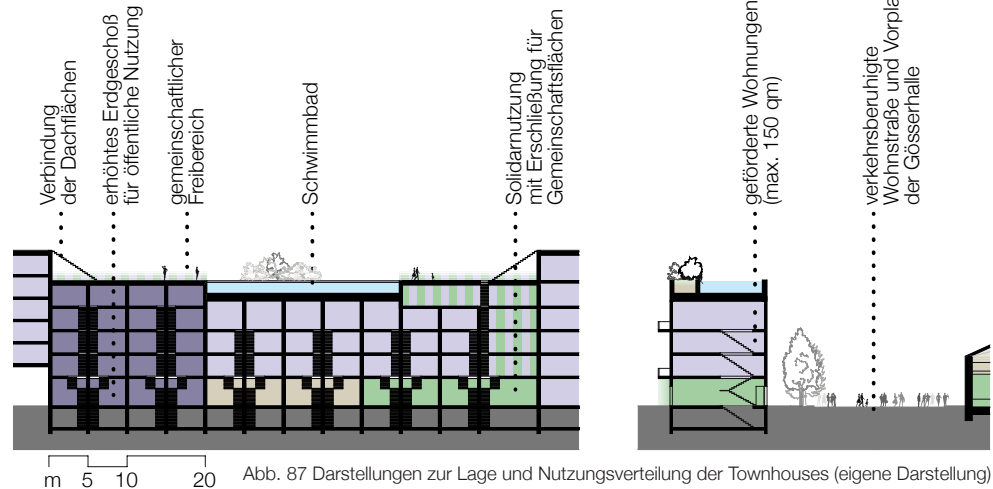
Darstellungen zur Lage und Nutzungsverteilung der Townhouses (eigene Darstellung)
